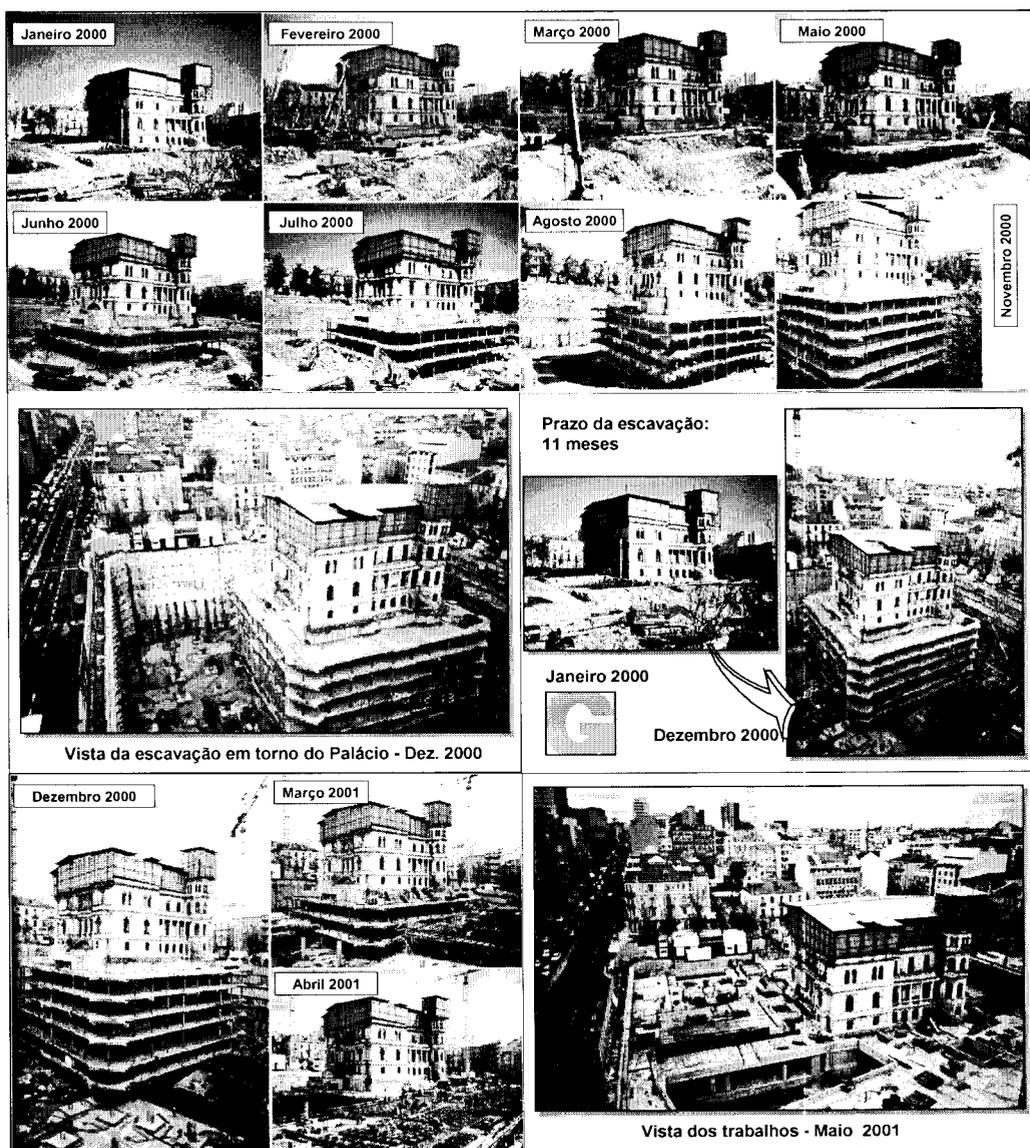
Escavação e construção de lajes em torno do Palácio.
